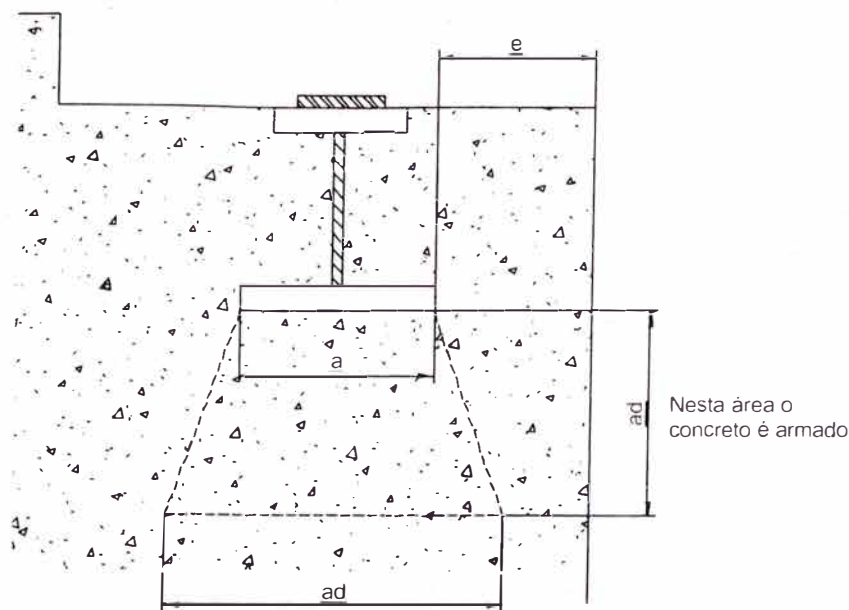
Seção transversal do caminho de rolamento ou de deslizamento
